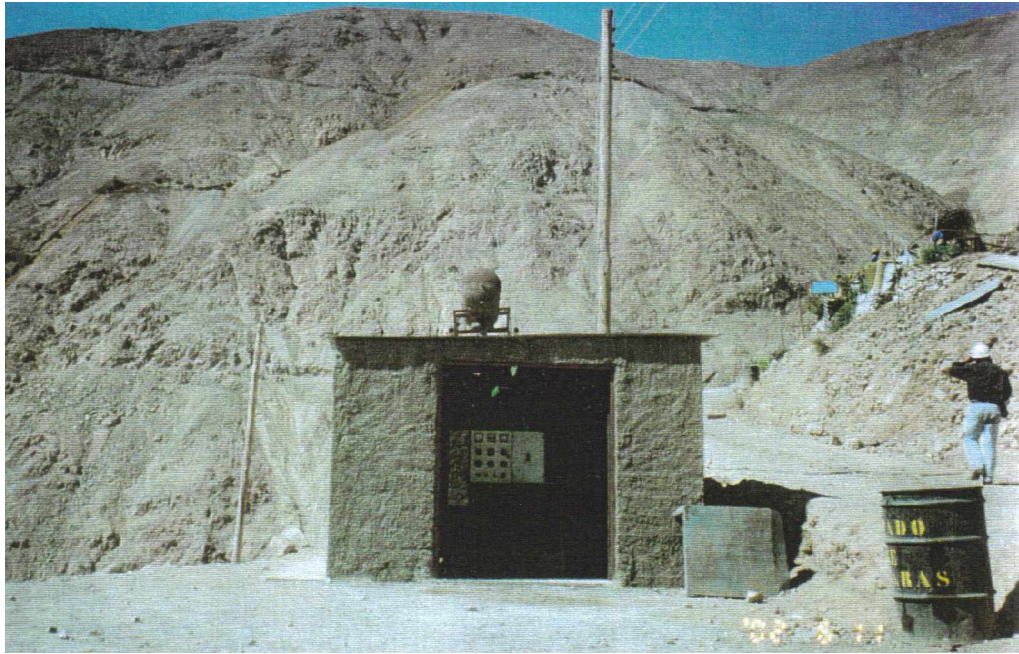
Grupo electrógeno en su caseta construida especialmente.
